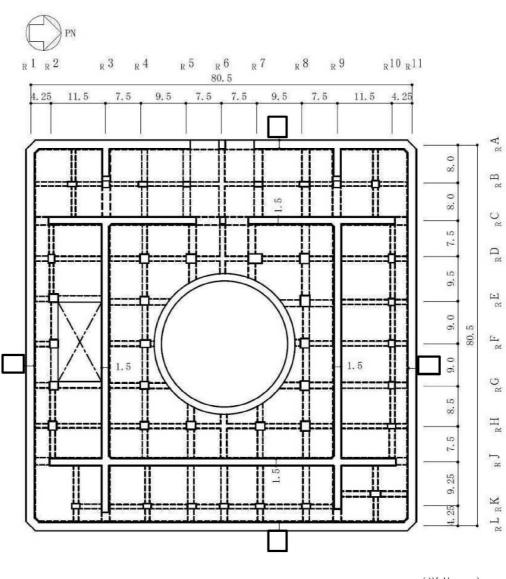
5 号機原子炉建屋の概略平面図 (B3F, T.M.S.L. -10.1m) (2/10)
